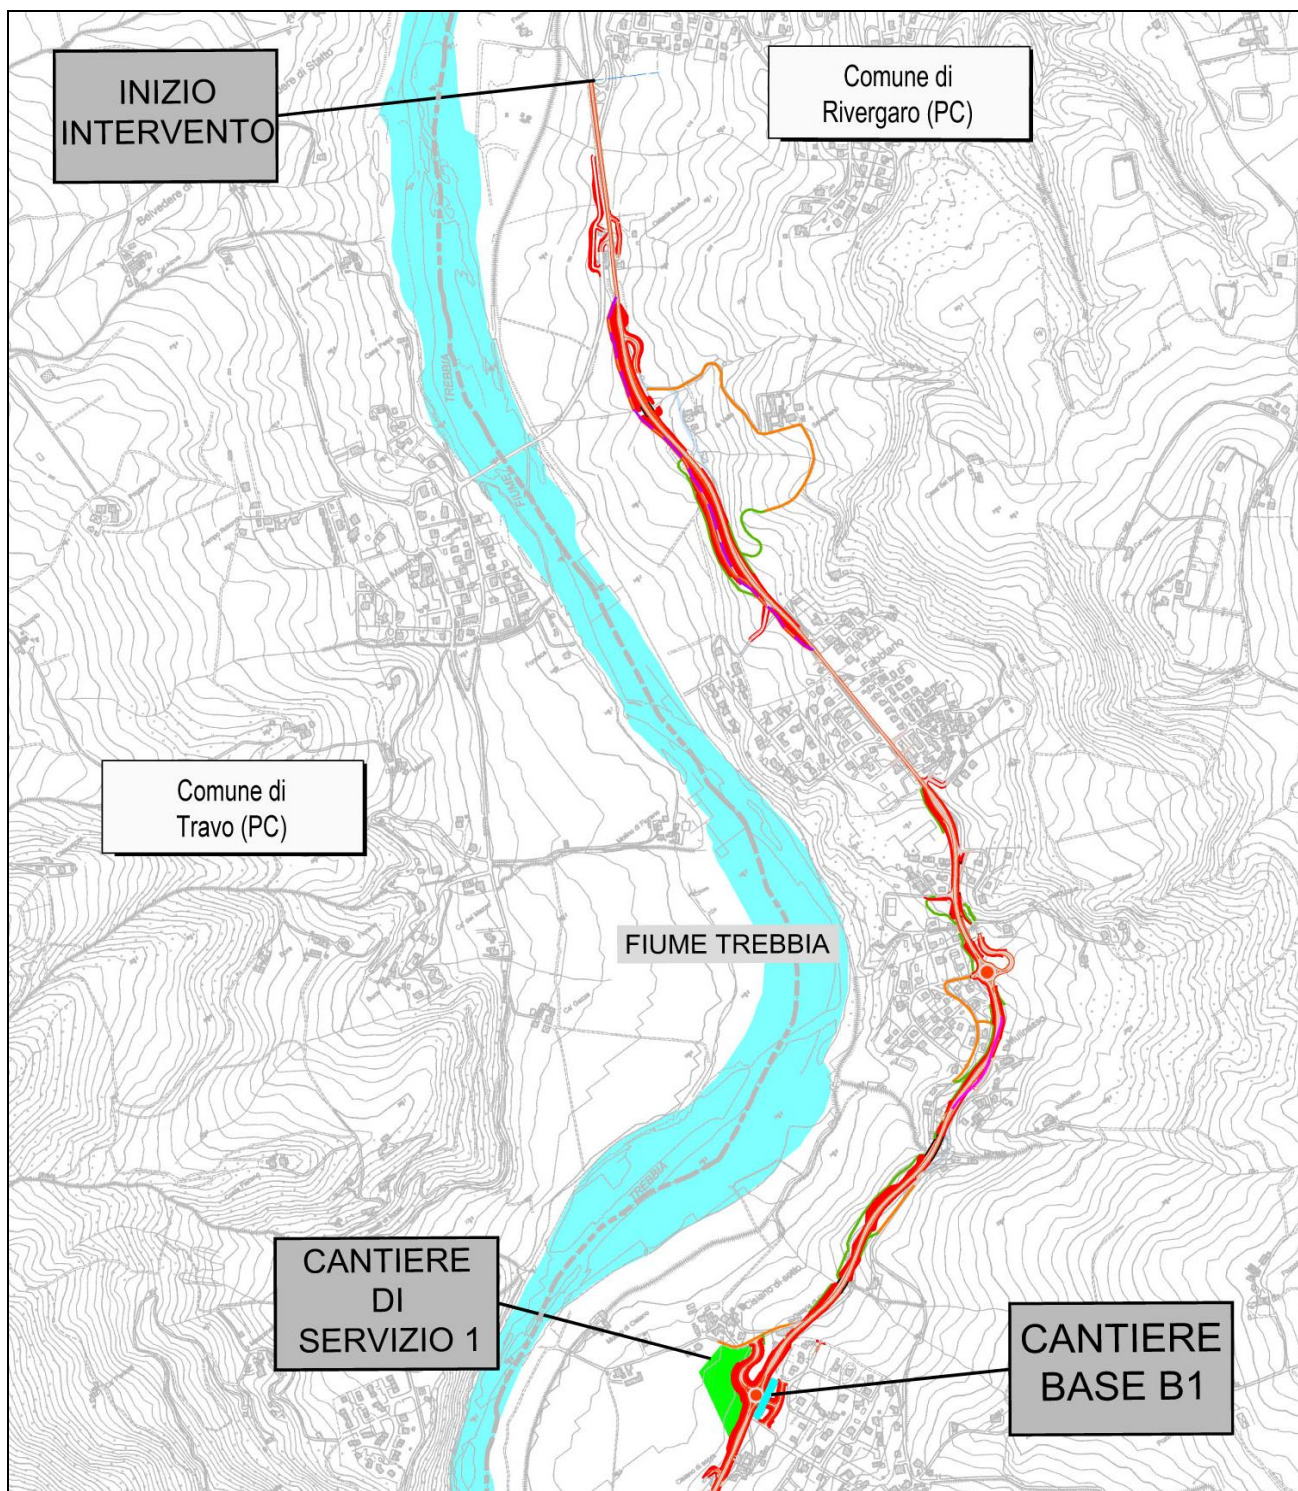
Tracciato in progetto e localizzazione delle aree di cantiere
